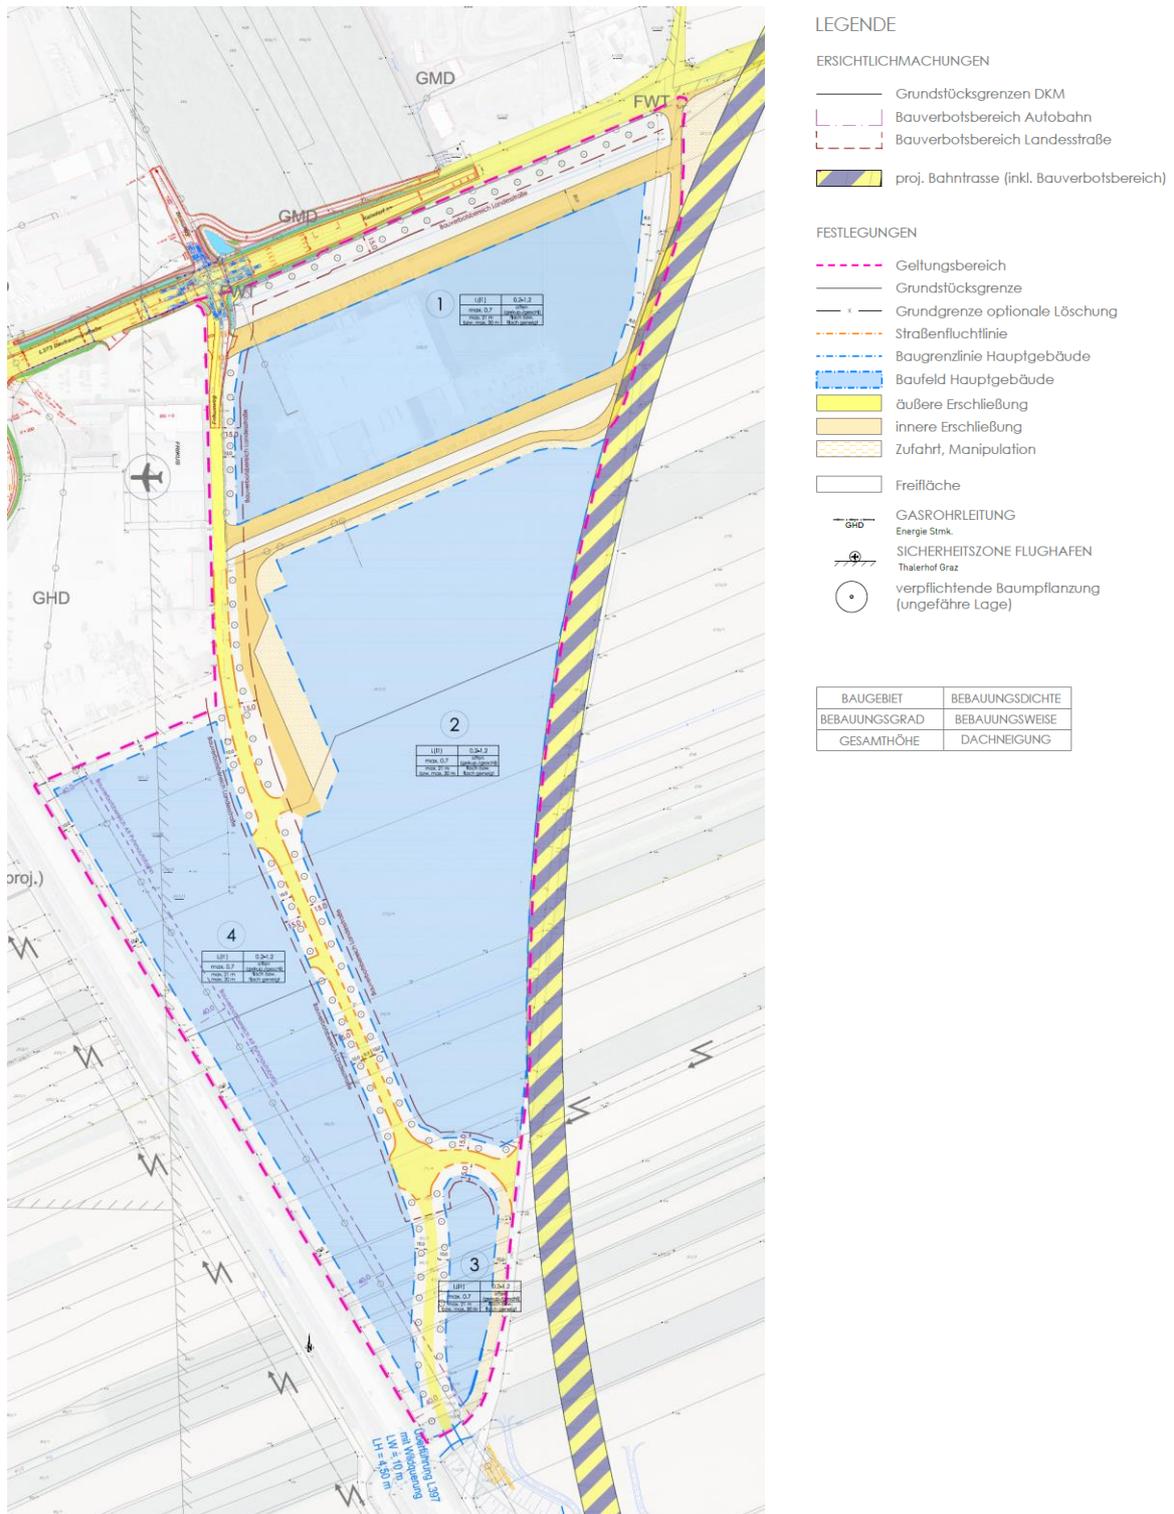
planische Darstellung „Bebauungsplan UBM 2018“, Premstätten¹¹²
